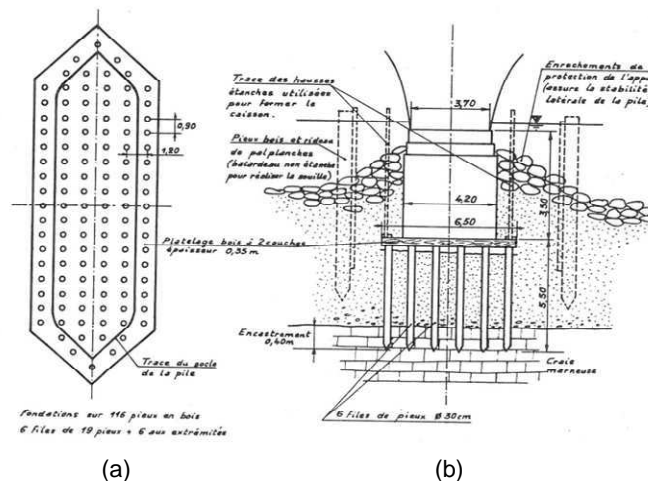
Fondations du pont de Saumur (Levillain, 1980)
